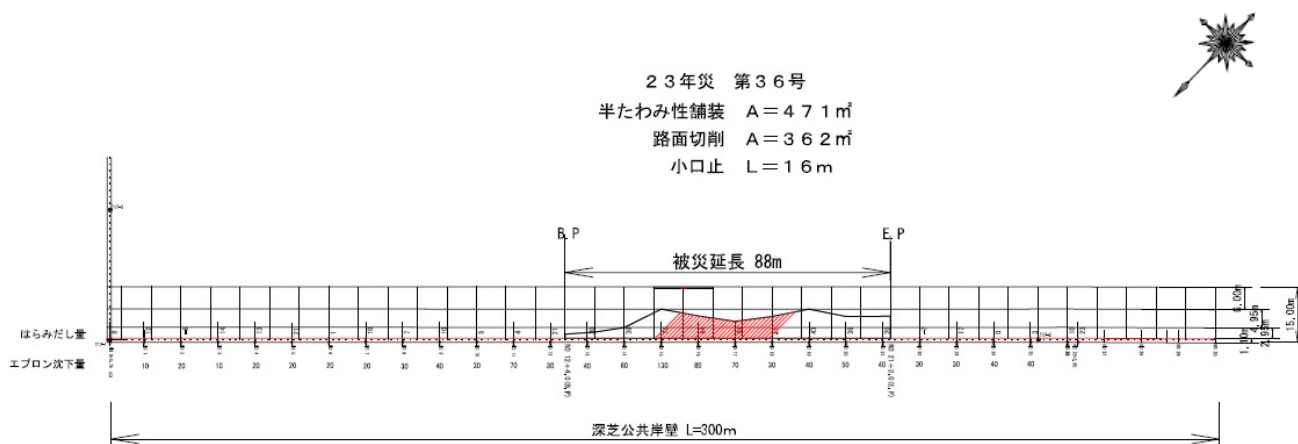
No.9 深芝公共埠頭岸壁の平面図（被災後）
